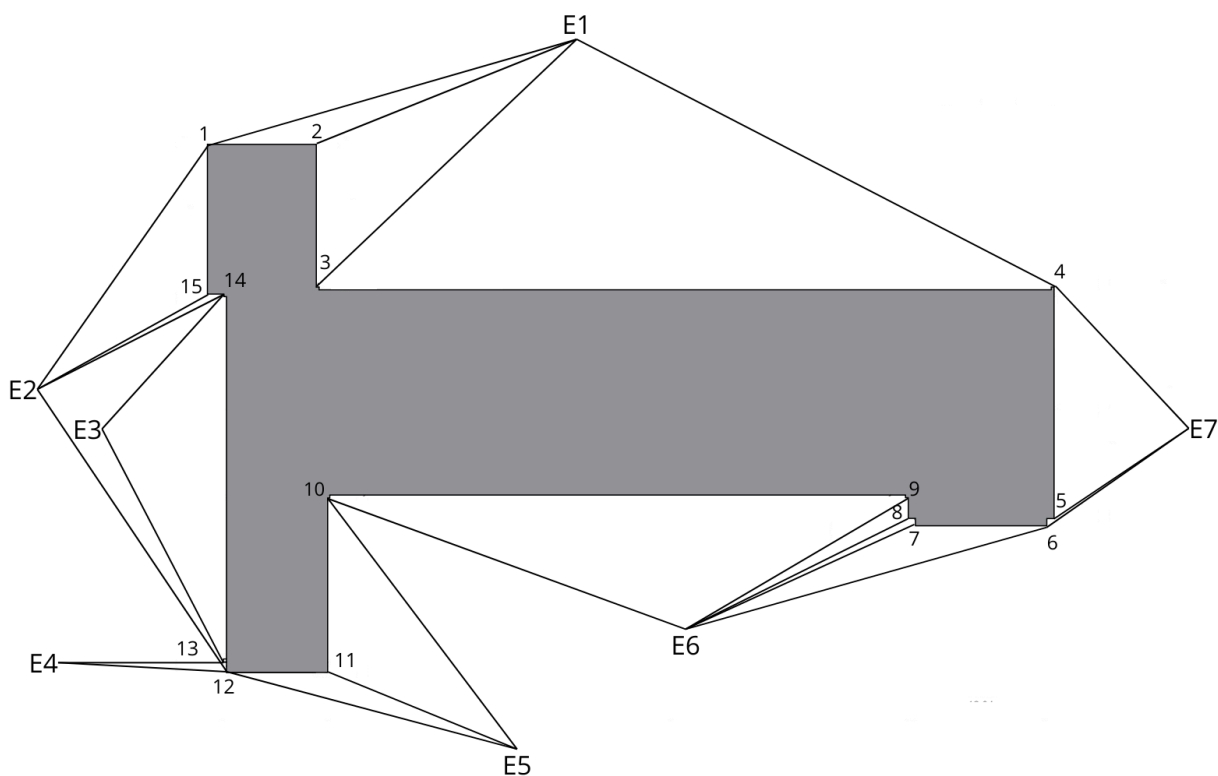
Croquis de relevamiento para el edificio del ala sur de la facultad de ingeniería.
